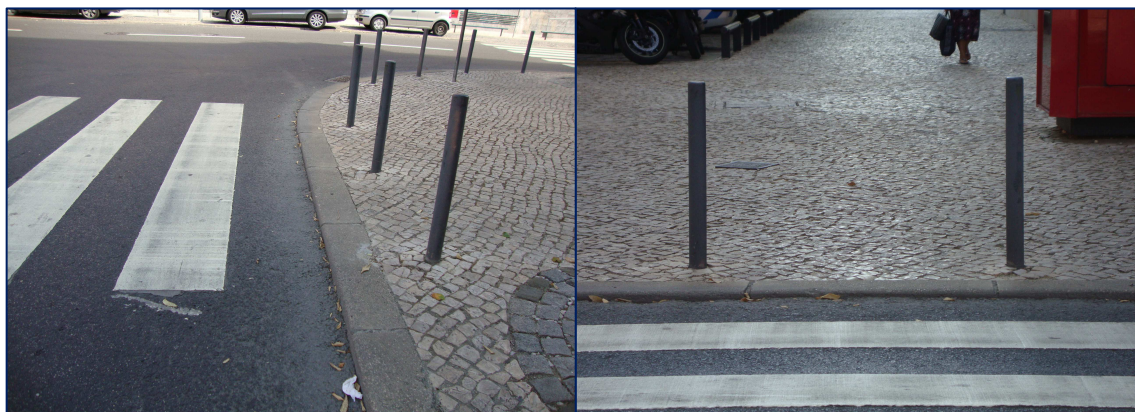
Inexistência de rebaixamento do passeio, junto à travessia de peões localizada na Avenida da Peregrinação (próximo da PSP)
